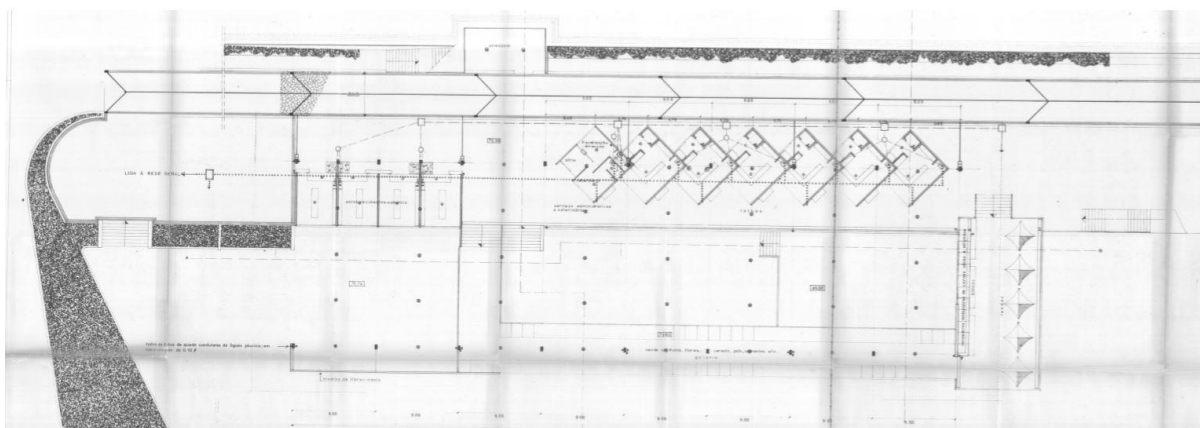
Mercado Municipal de Amarante, planta do piso térreo
